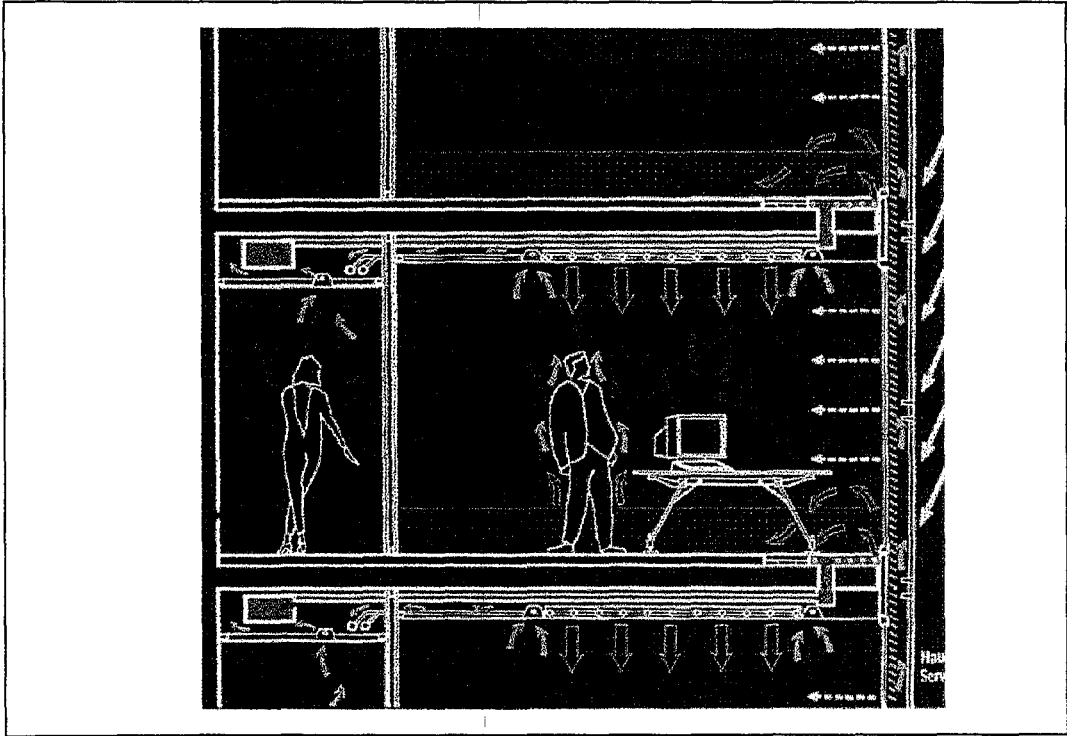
Hooker Building, Buffalo, New York, 1981 (Behling ve Behling 1996)
